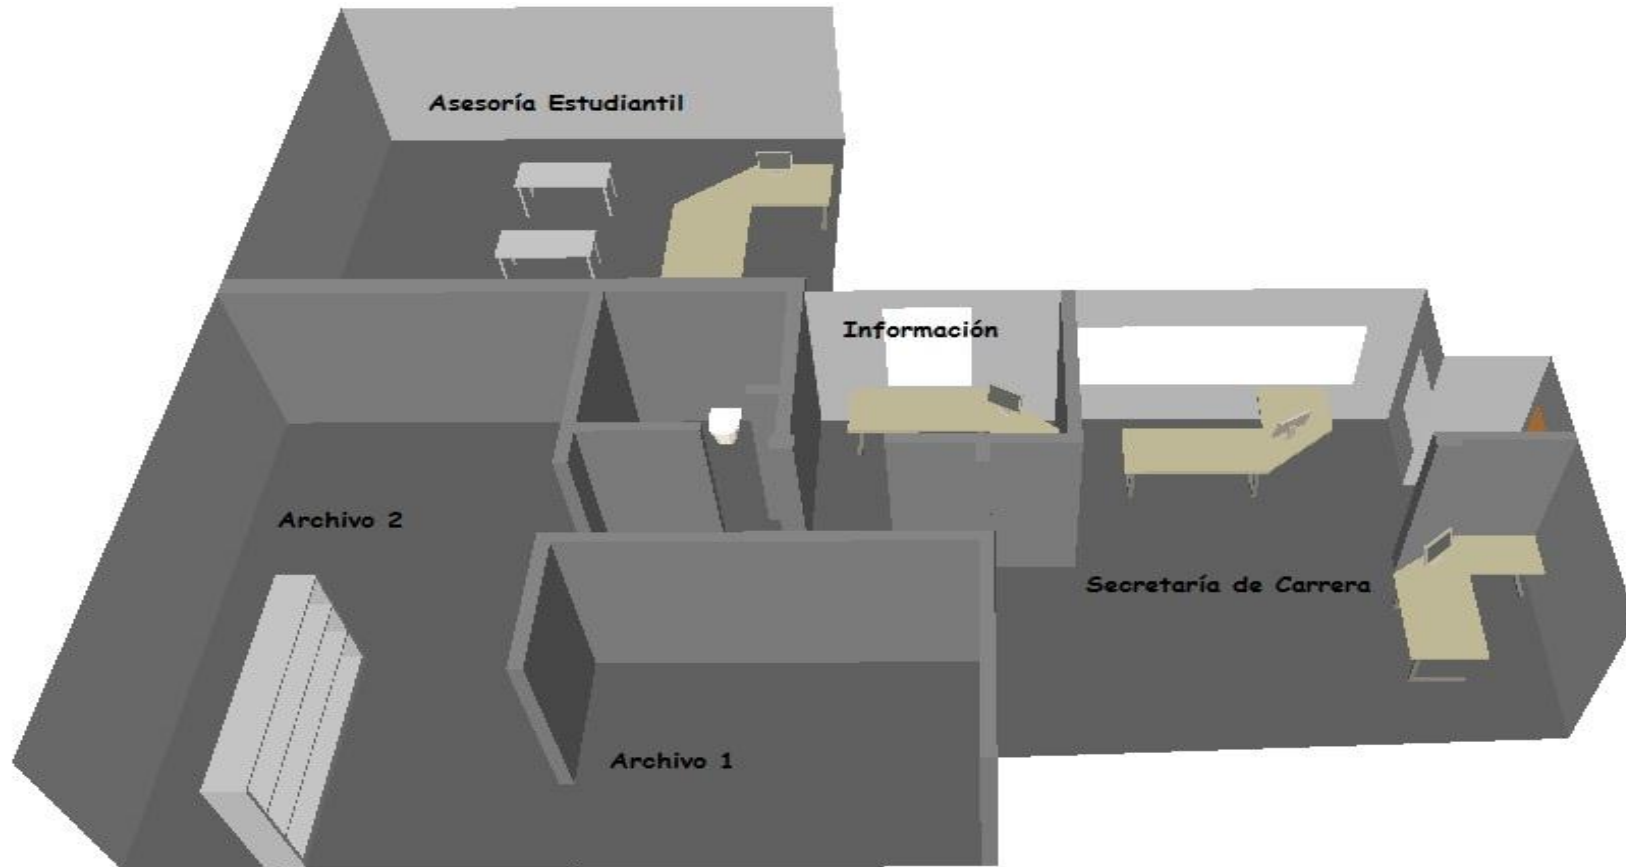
Plano tipo X Distribución de las oficinas planta baja A
